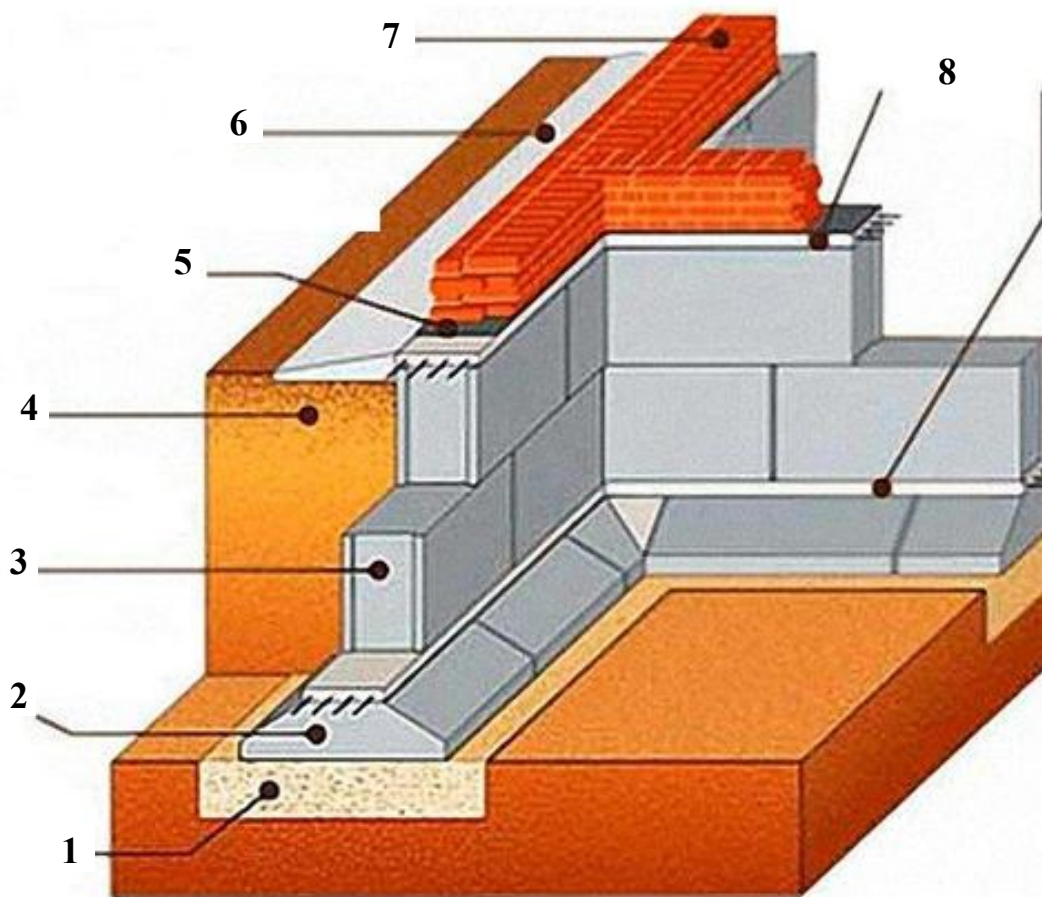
Конструкція збірного бетонного фундаменту: 1 – піщана подушка; 2 – фундаментна плита; 3 – фундаментний блок; 4 – ґрунт; 5 – гідроізоляція; 6 – вимощення; 7 – стіна цоколя; 8 – армований залізобетонний пояс
